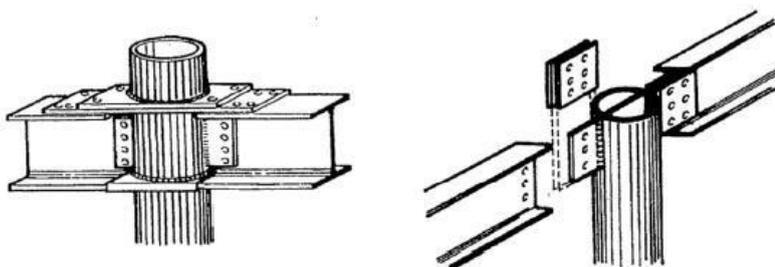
Assemblage des poteaux tubulaire poteaux /poutre.
